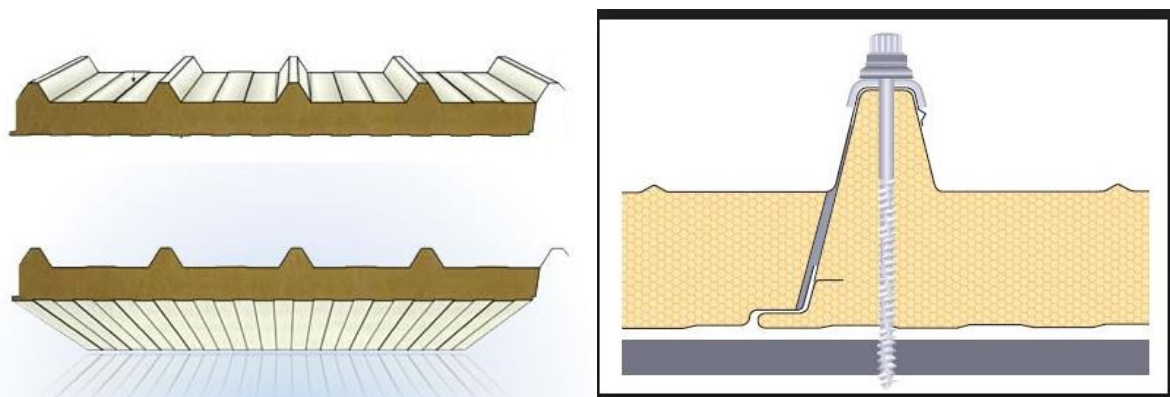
Panel tipo sándwich de cubierta / Detalle de empernado
